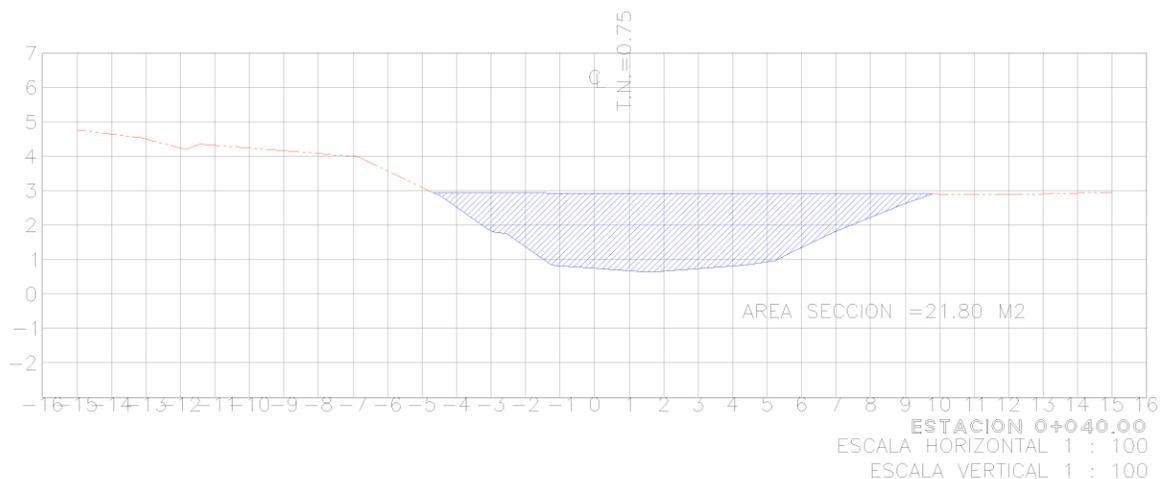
Sección de levantamiento topográfico de área de dren.
